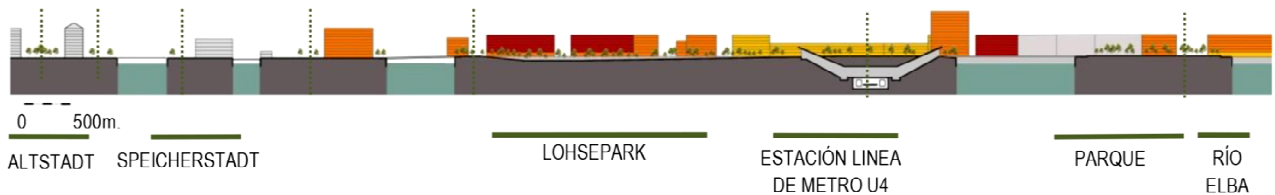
Sección C: Calle Poggenmühle y Calle Am Hannoverschen Bahnhof.
